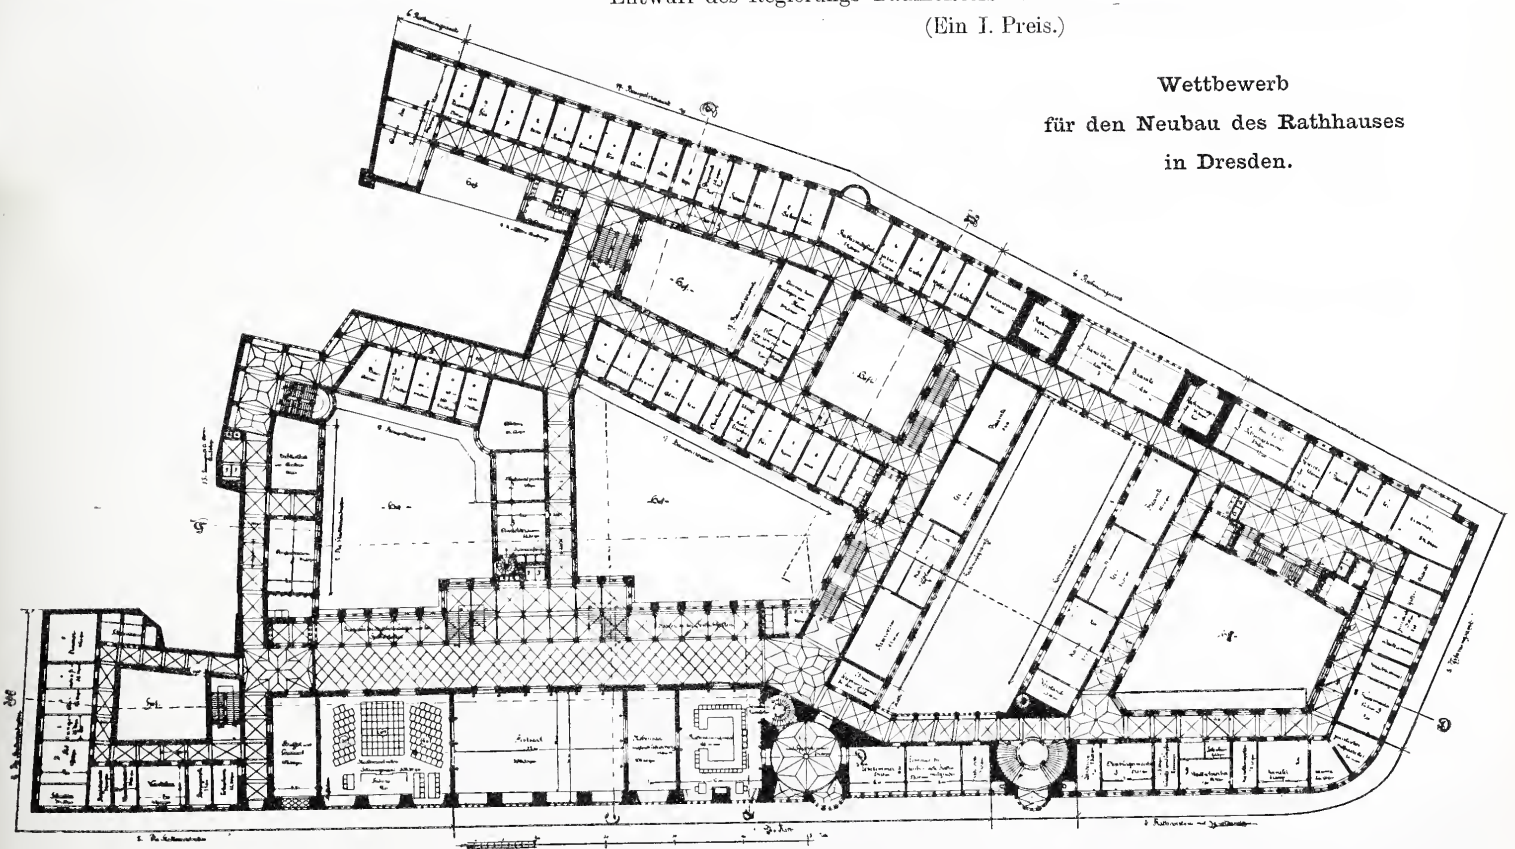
Grundriss vom zweiten Obergeschoß (Hauptgeschoss).
